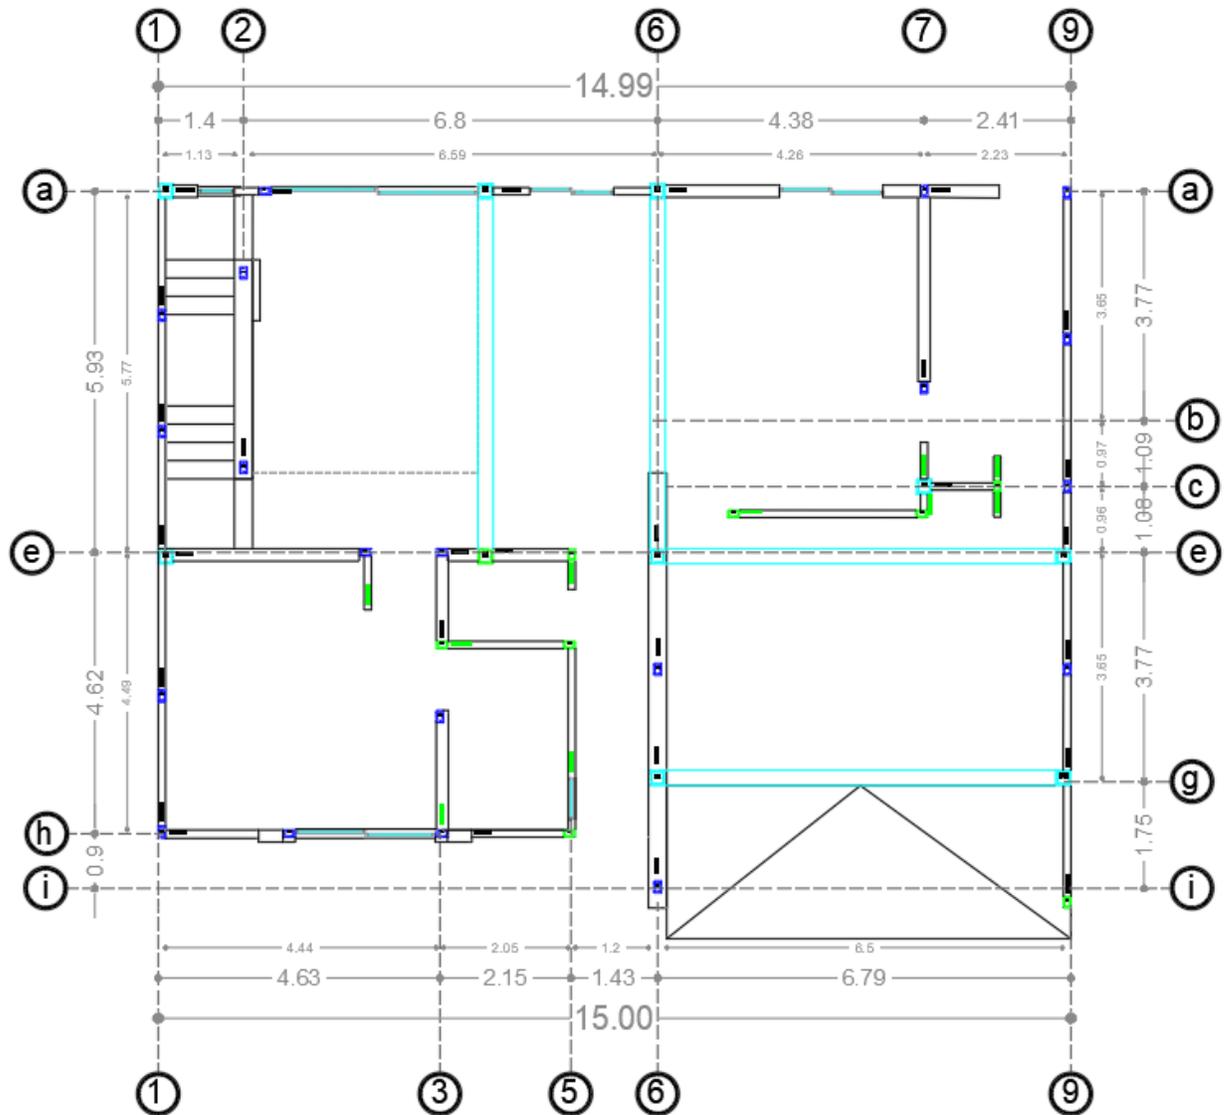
Plano Columnas, Castillos y Traves (Muciño, 2022)
